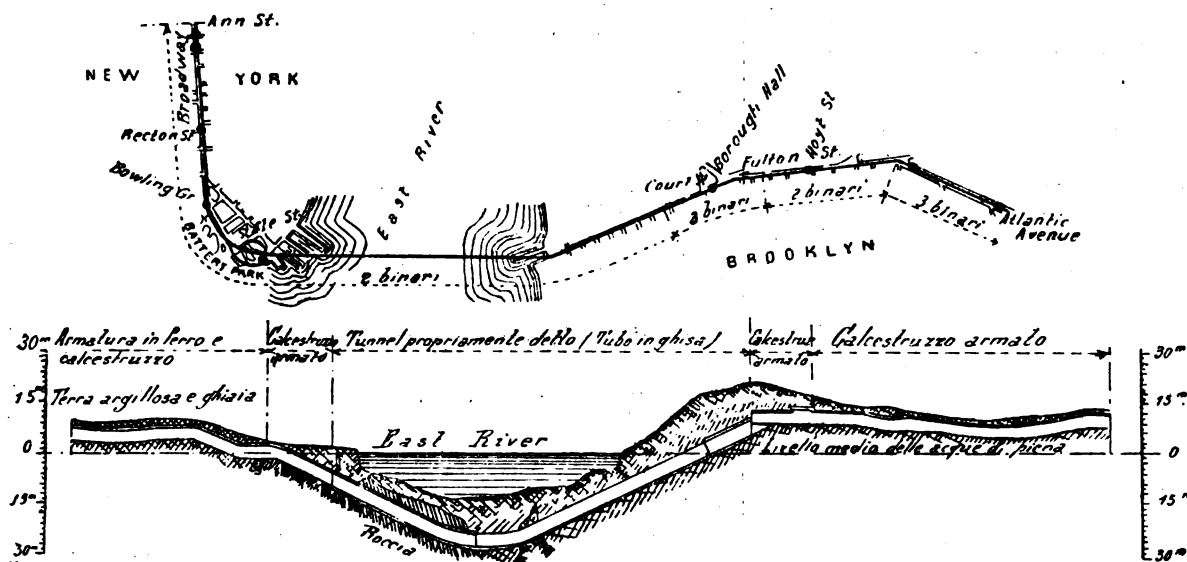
Planimetria e profilo longitudinale delle due gallerie.
